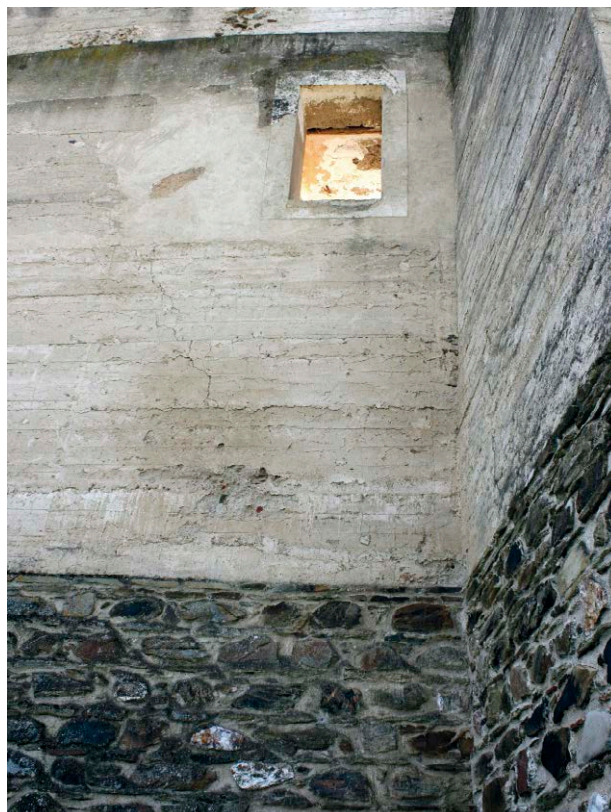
Fisuración en zonas de rellenos profundos
